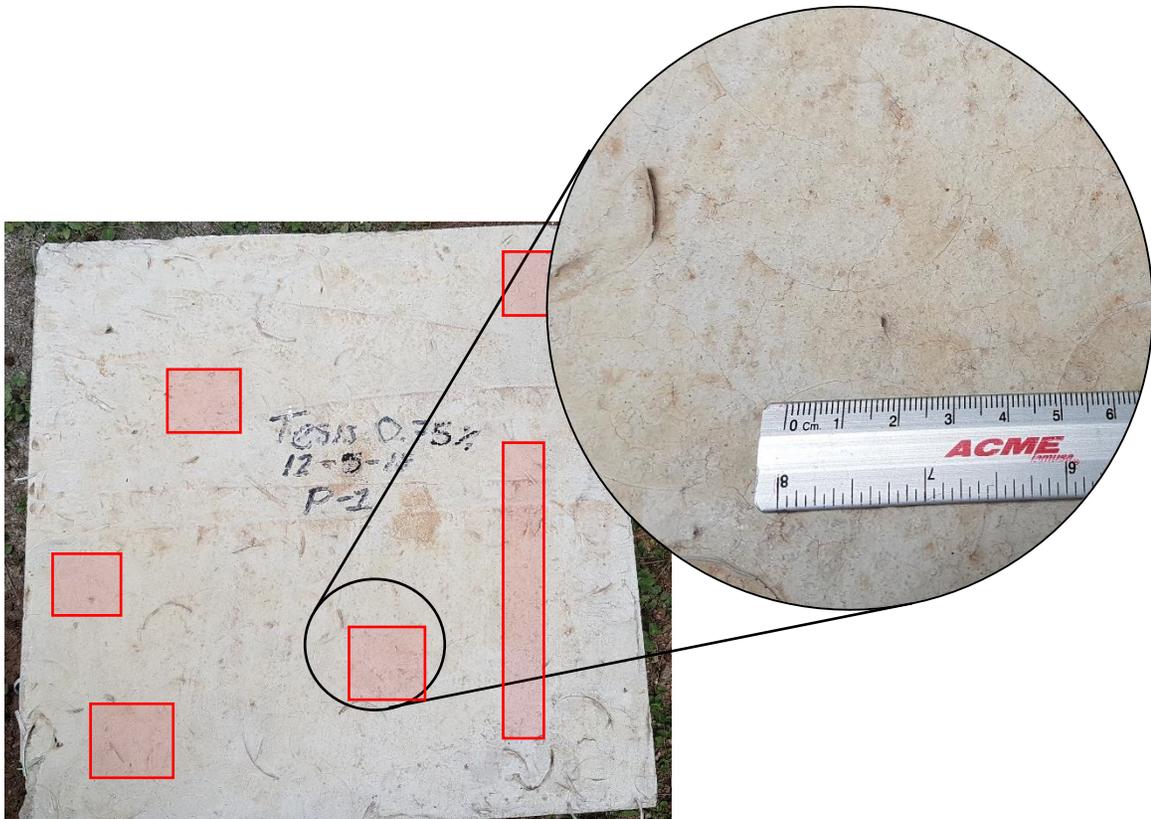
Losa CONCREPET con 0.75% de fibra, 20% fisurada a 21 días
